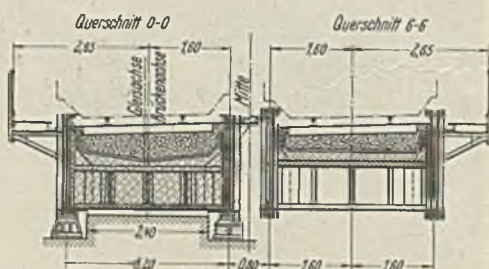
Stählerne Überbauten mit Fahrbahnplatte aus Eisenbeton bei der Schillerstraßenunterführung.
